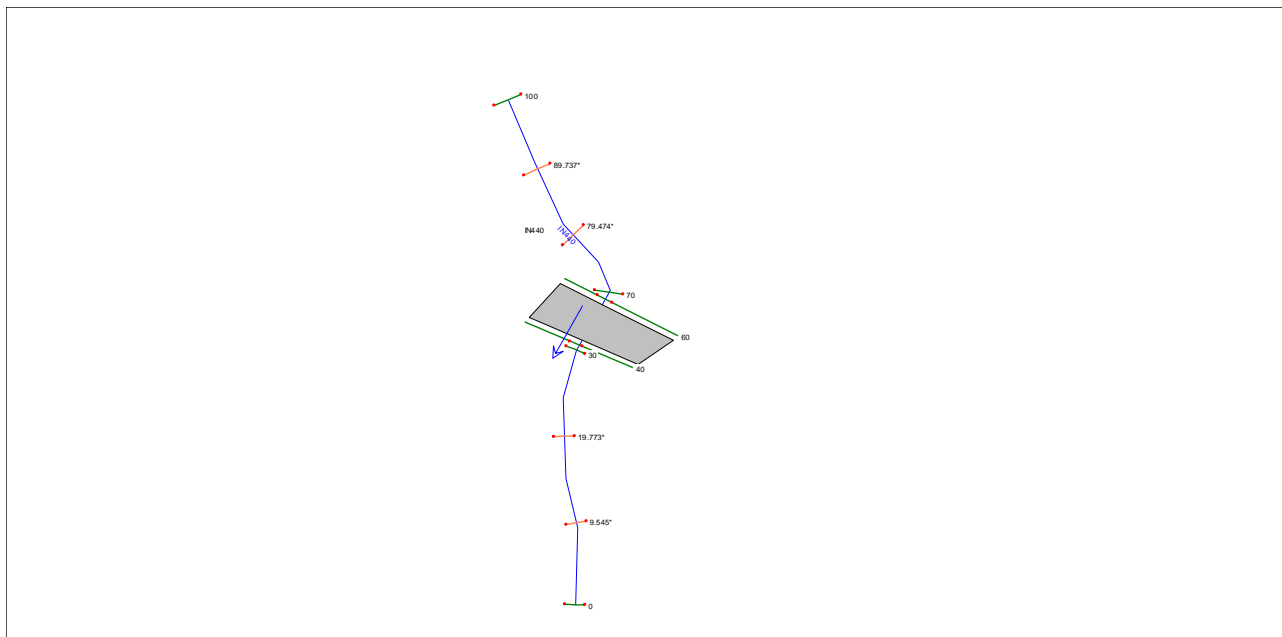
Planimetria modello 1D – stato di fatto interferenza IN440.
